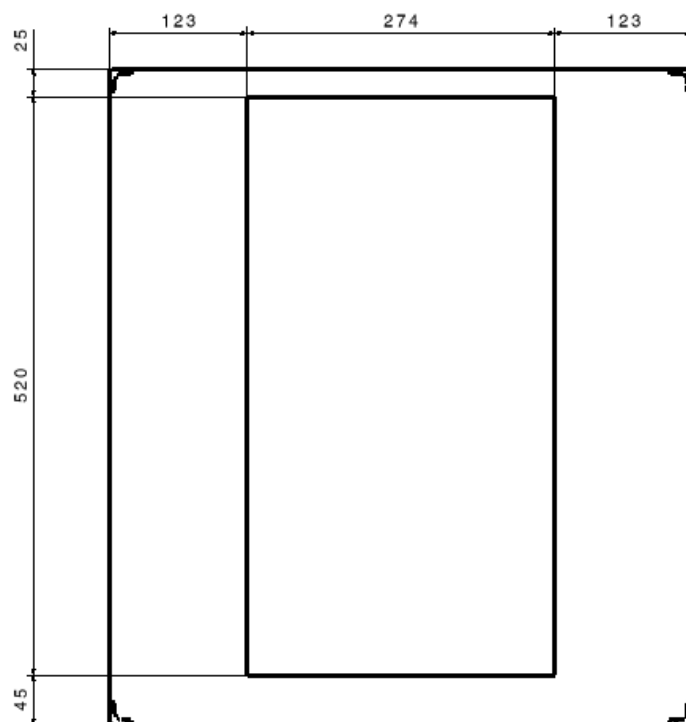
Plano de planta de la piscina de combustible (cotas en mm) [1]
